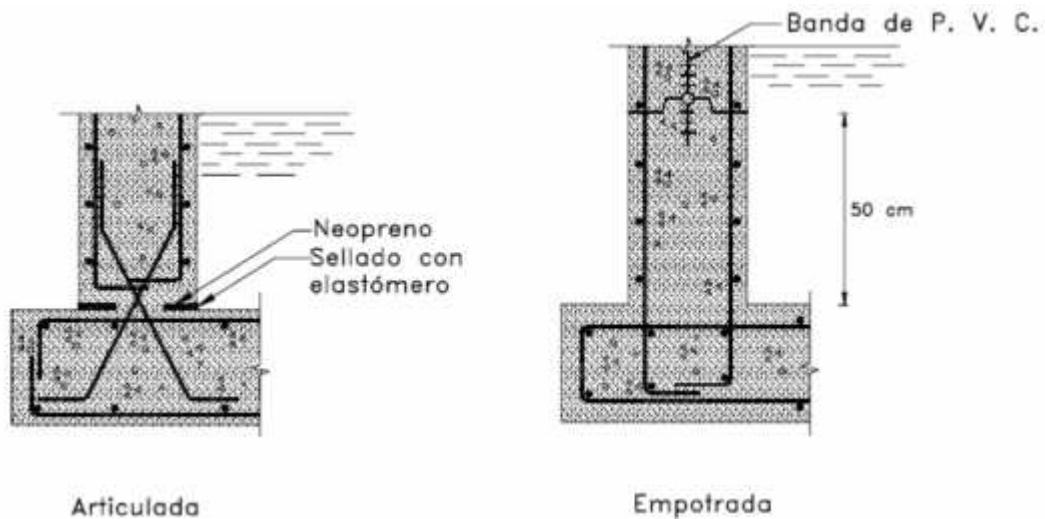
Uniones empotradas y articuladas entre el muro y la zapata
